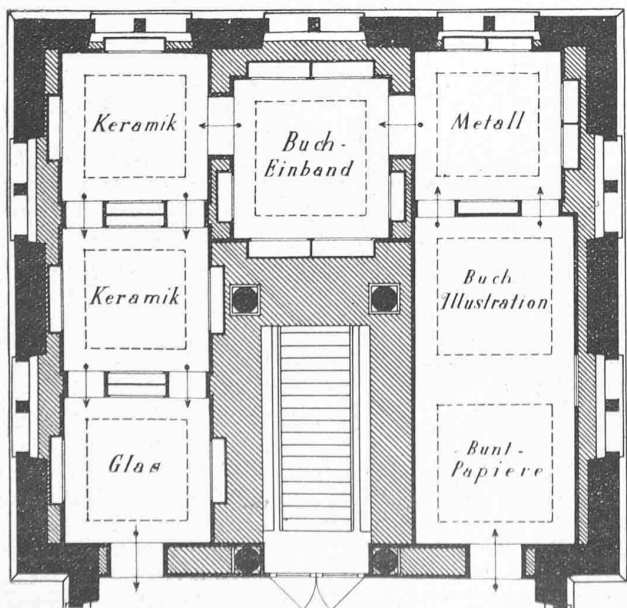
Grundriss, Masstab etwa 1:170. — Ausstellungs-Vitrinen im Kunstgewerbe-Museum Zürich.
